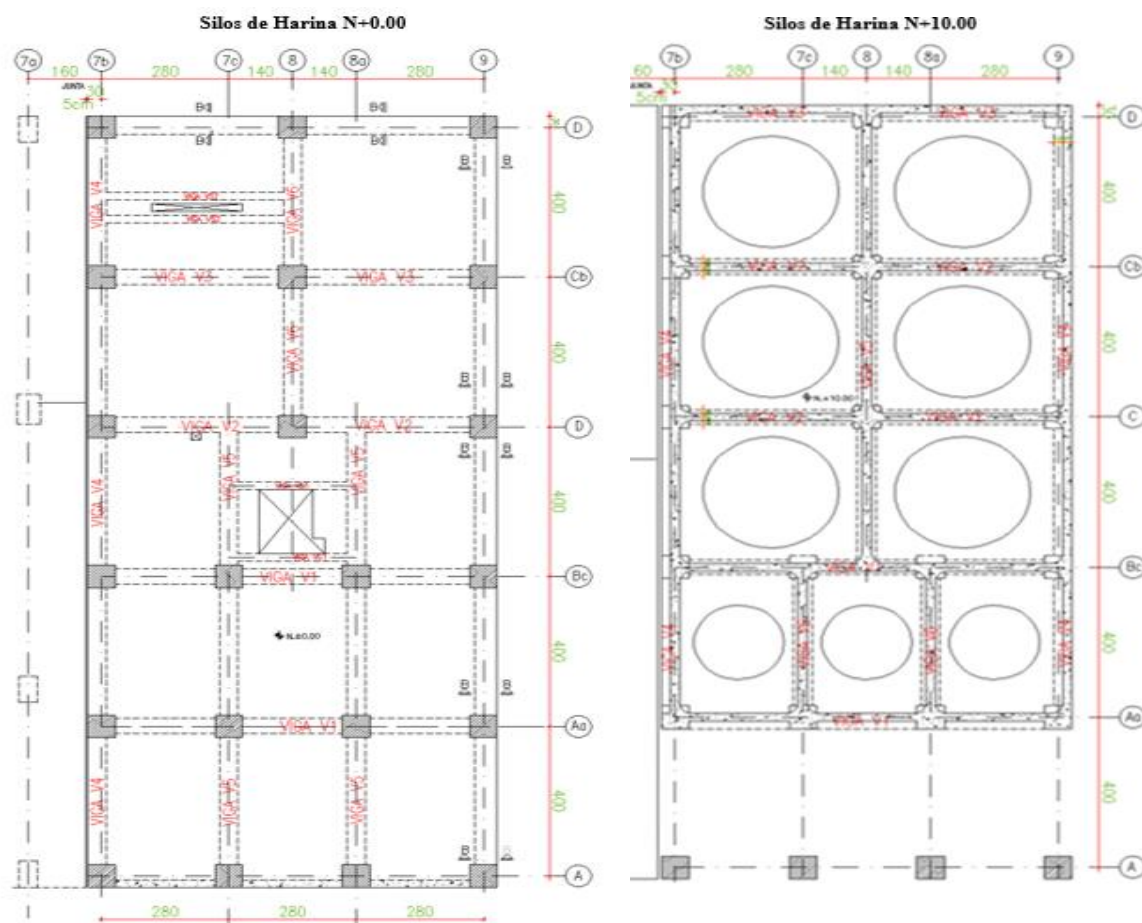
Vista en planta de las vigas, columnas y ductos de los niveles N 0,00 y N 10,00 m.
